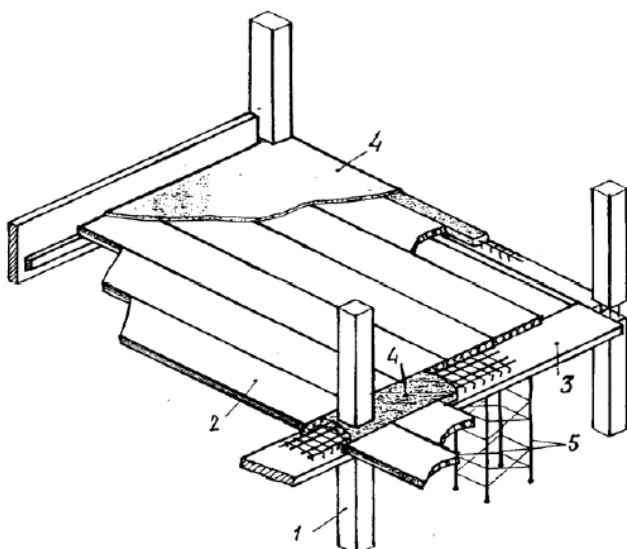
Схема перекрытий системы Дусоре: 1 – колонна, 2 – многопустотная плита, 3 – нижний сборный элемент балки, 4 – монолитный бетон
